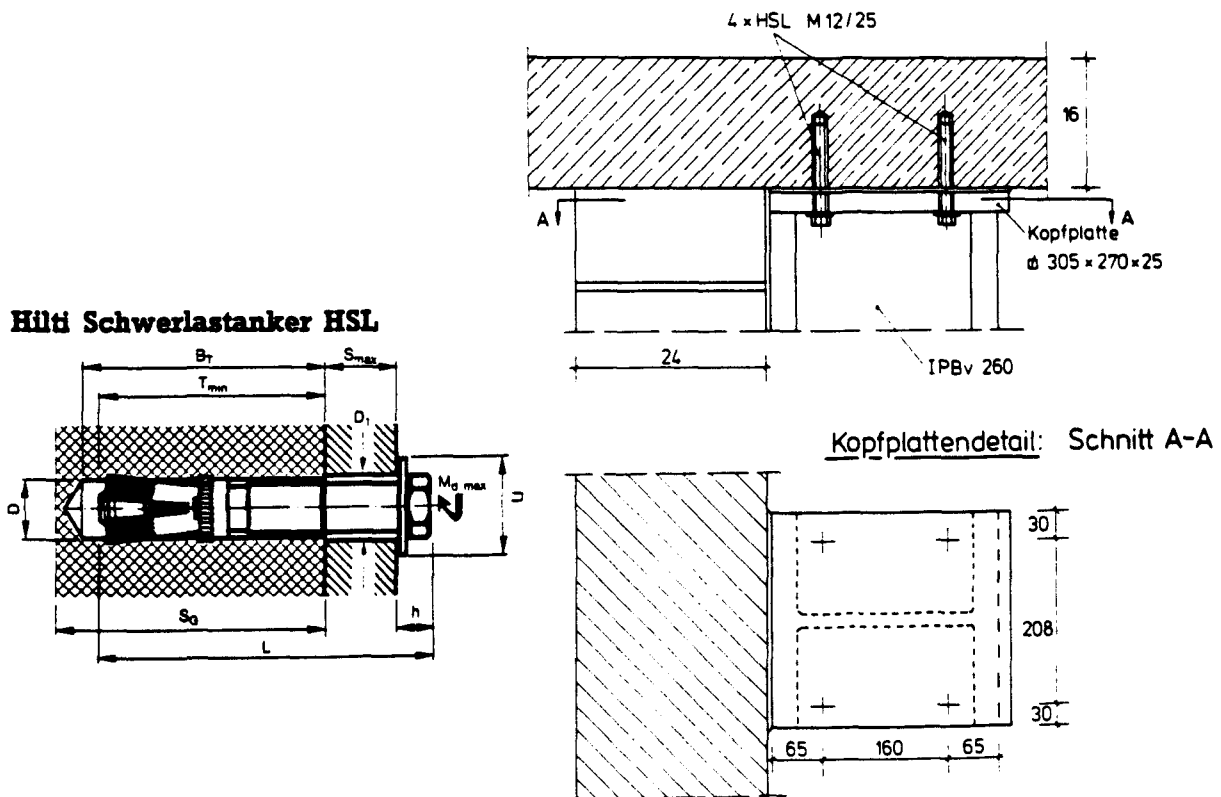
Anschlußkonstruktion einer Pfeilervorlage an die Decke
